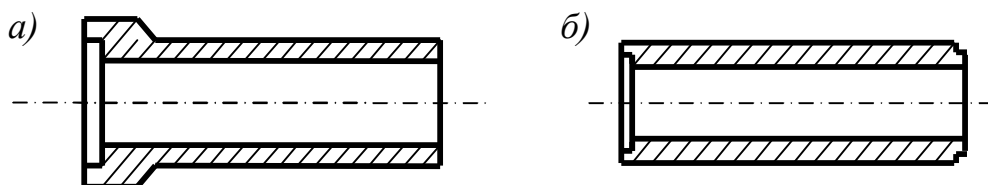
Железобетонные трубы для водостоков: а – раструбные; б – фальцевые
